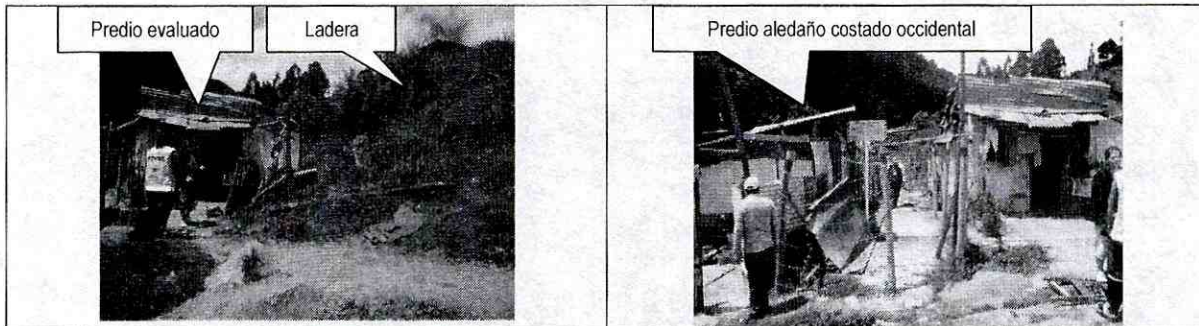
Se observa la vivienda de la Manzana 26 Lote 14 del Barrio Laureles Suroriental Primer Sector de la Localidad de San Cristóbal, donde habita la Sra. Elvira Buitrago Toro, construida con material de recuperación. Hacia el costado oriental se observa ladera con pendiente de 50° grados y grietas en la parte alta.
